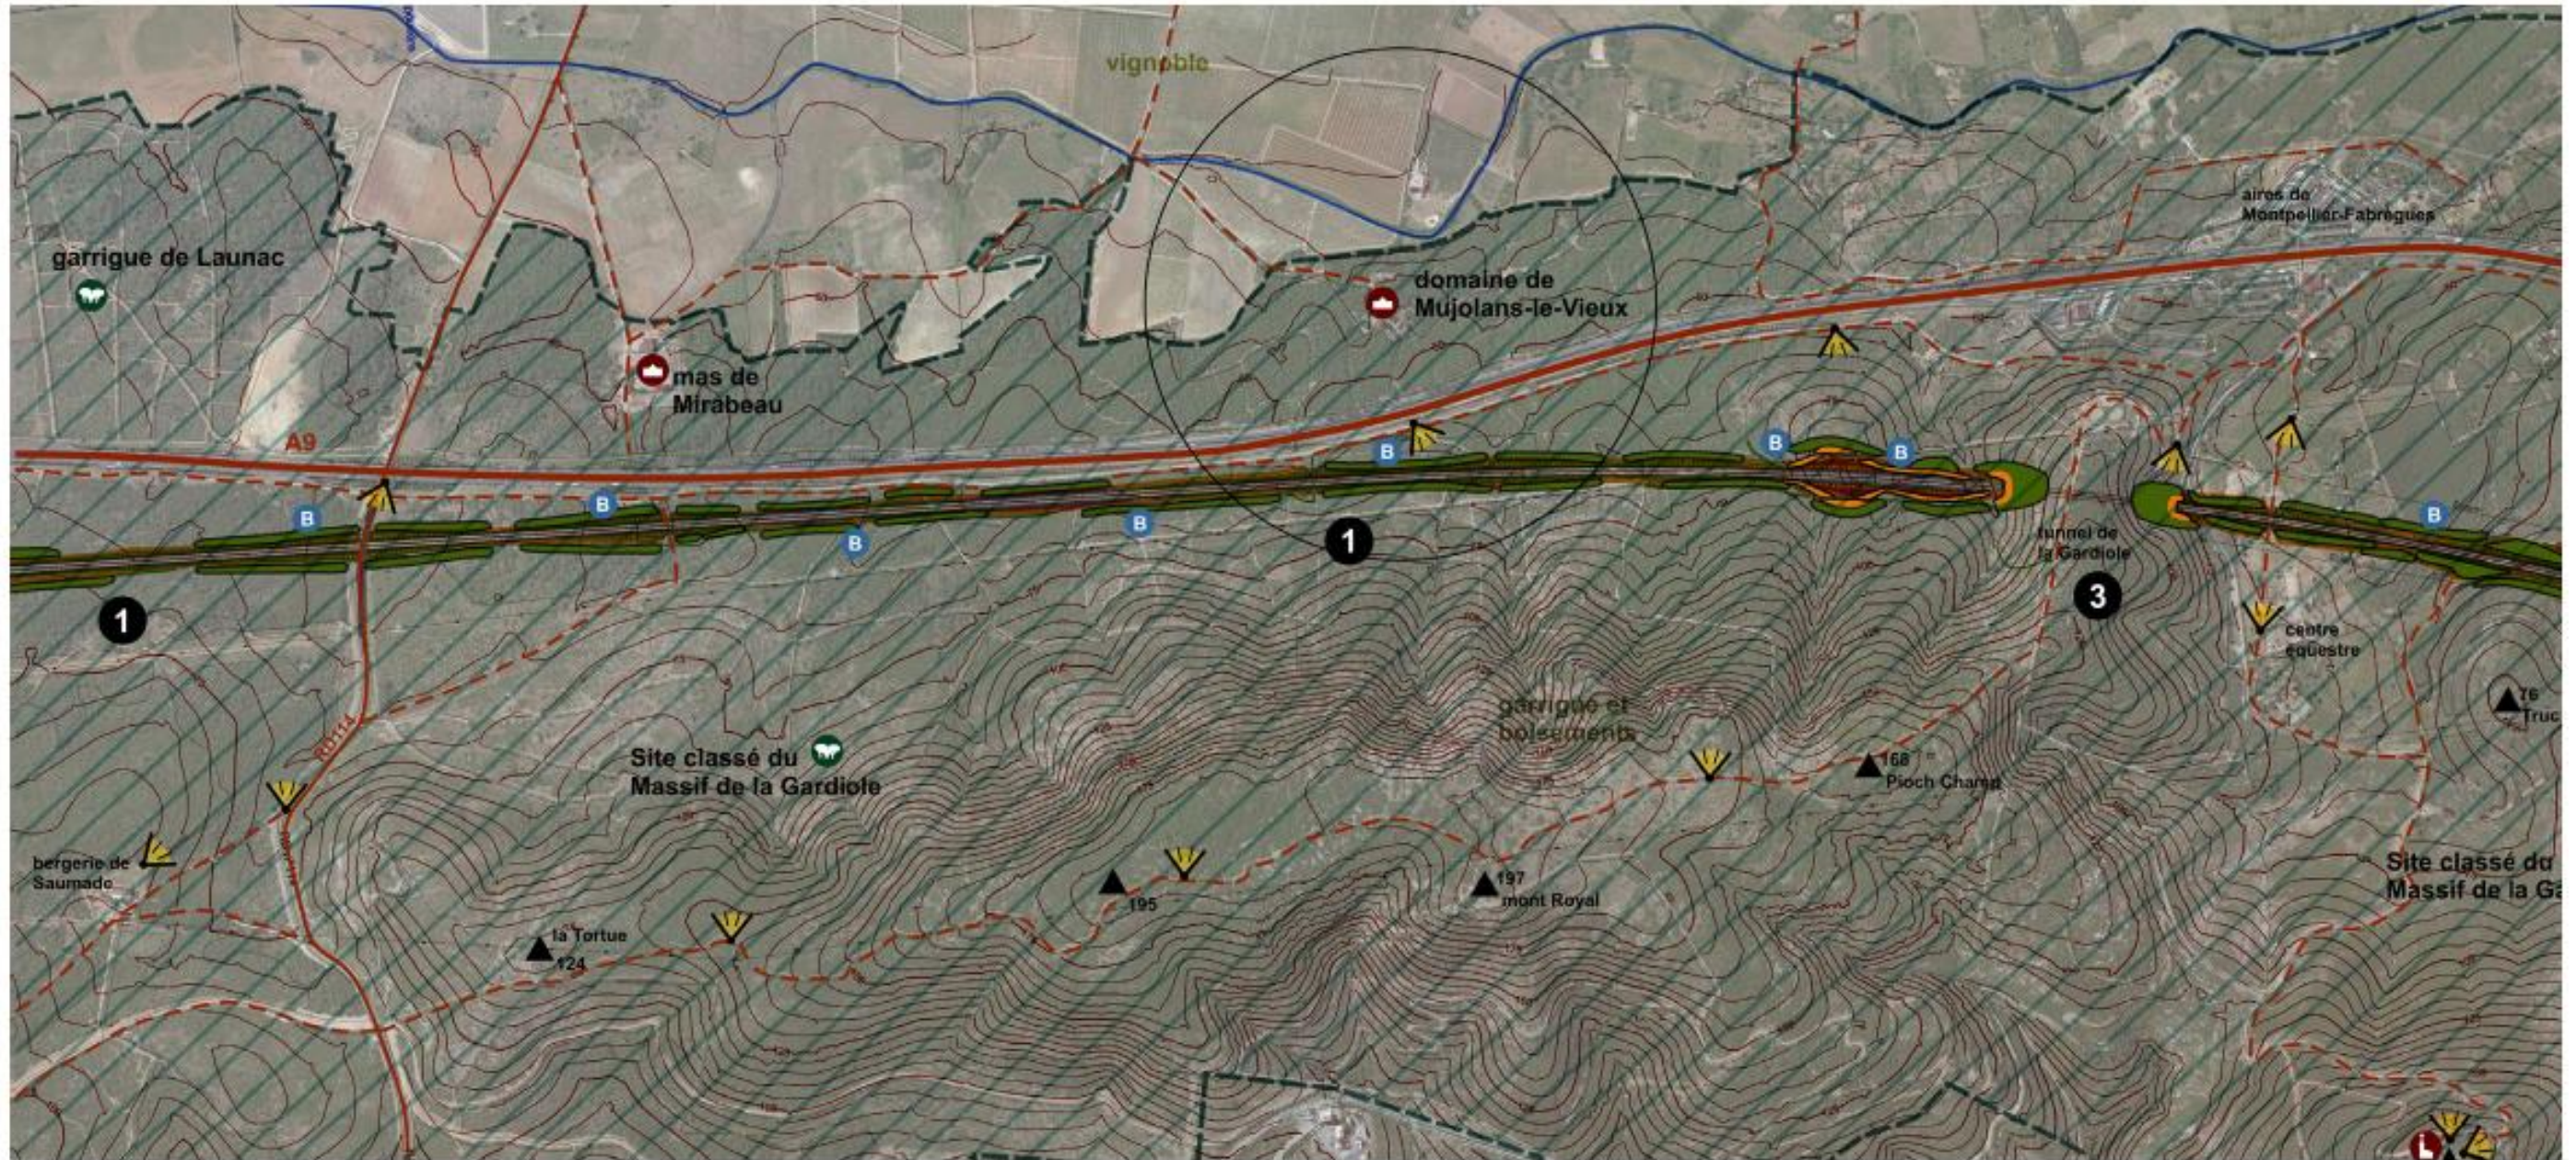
plan des mesures paysagères dans la traversée de la Gardiole (planche 2) (source : Traverses)
